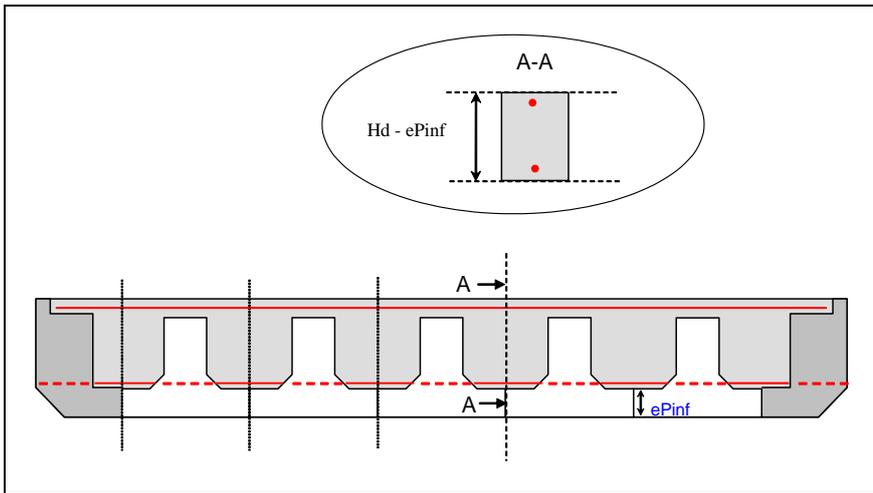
Sections étudiées en flexion transversale PRAD Tablier Dalle Composite
